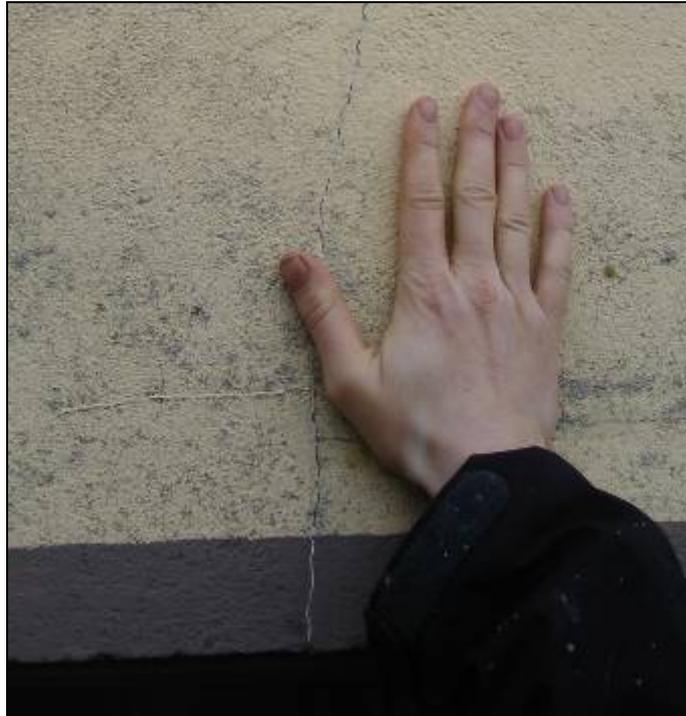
Fissure sur le bâtiment du côté est jouxtant la terrasse, derrière la maison de M. Sahling (déjà vue en mars 2008).
